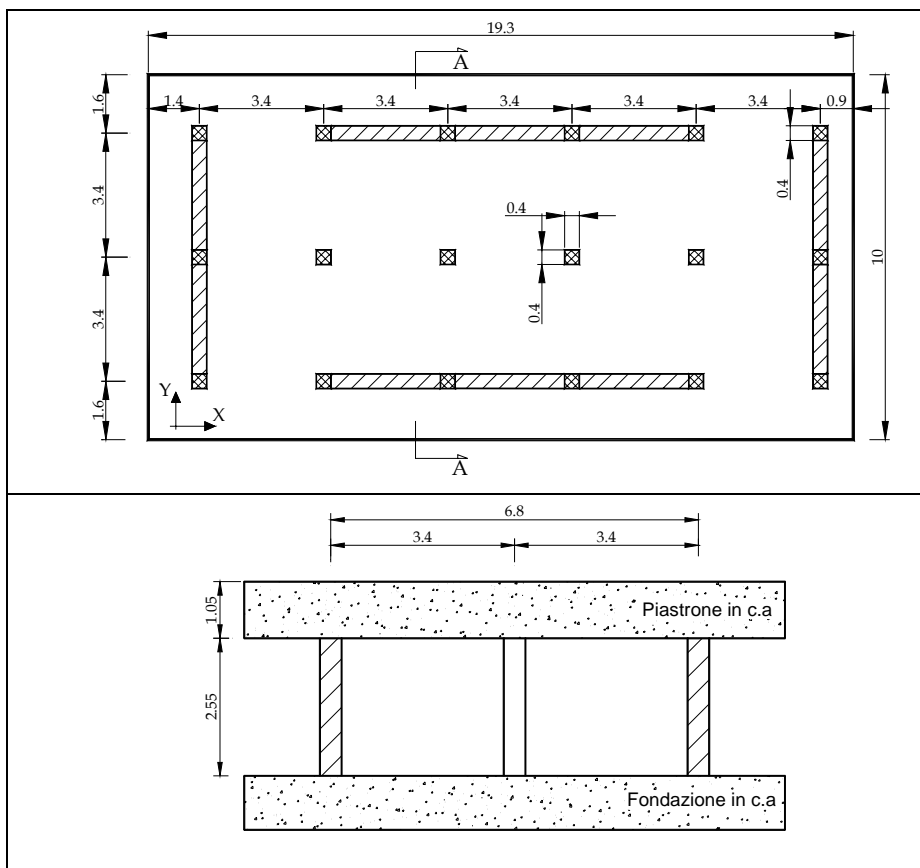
Pianta e sezione della massa di contrasto (misure in m)
